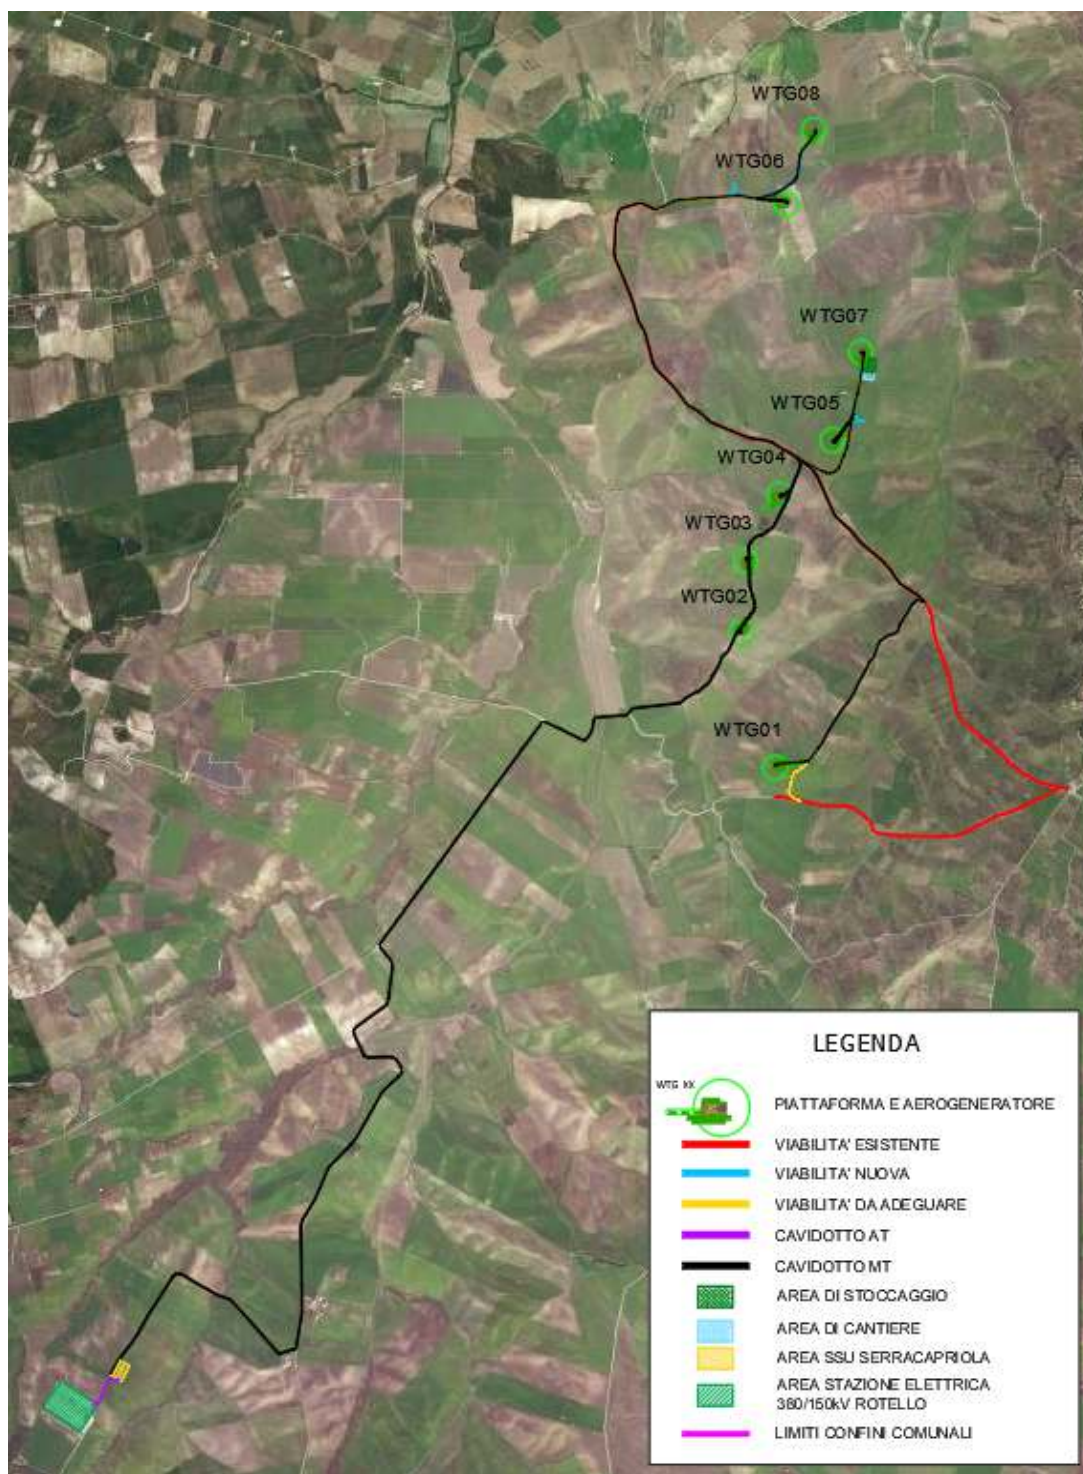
Individuazione su ortofoto dell'impianto in progetto.
